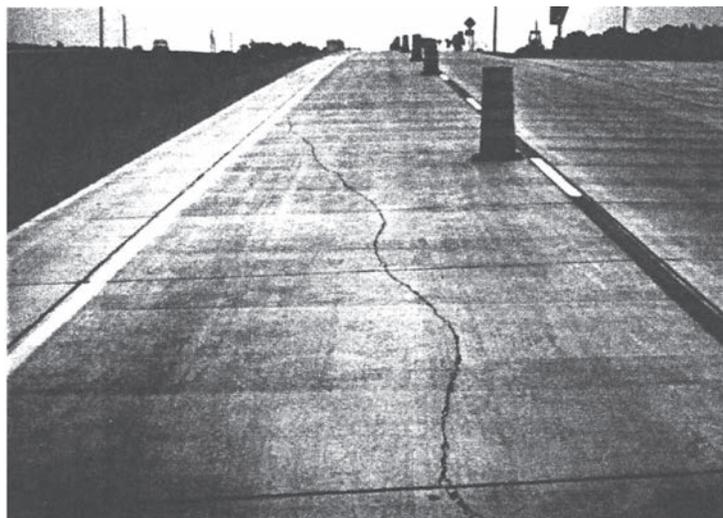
普通コンクリート舗装区間の追越車線に発生した縦ひび割れ
